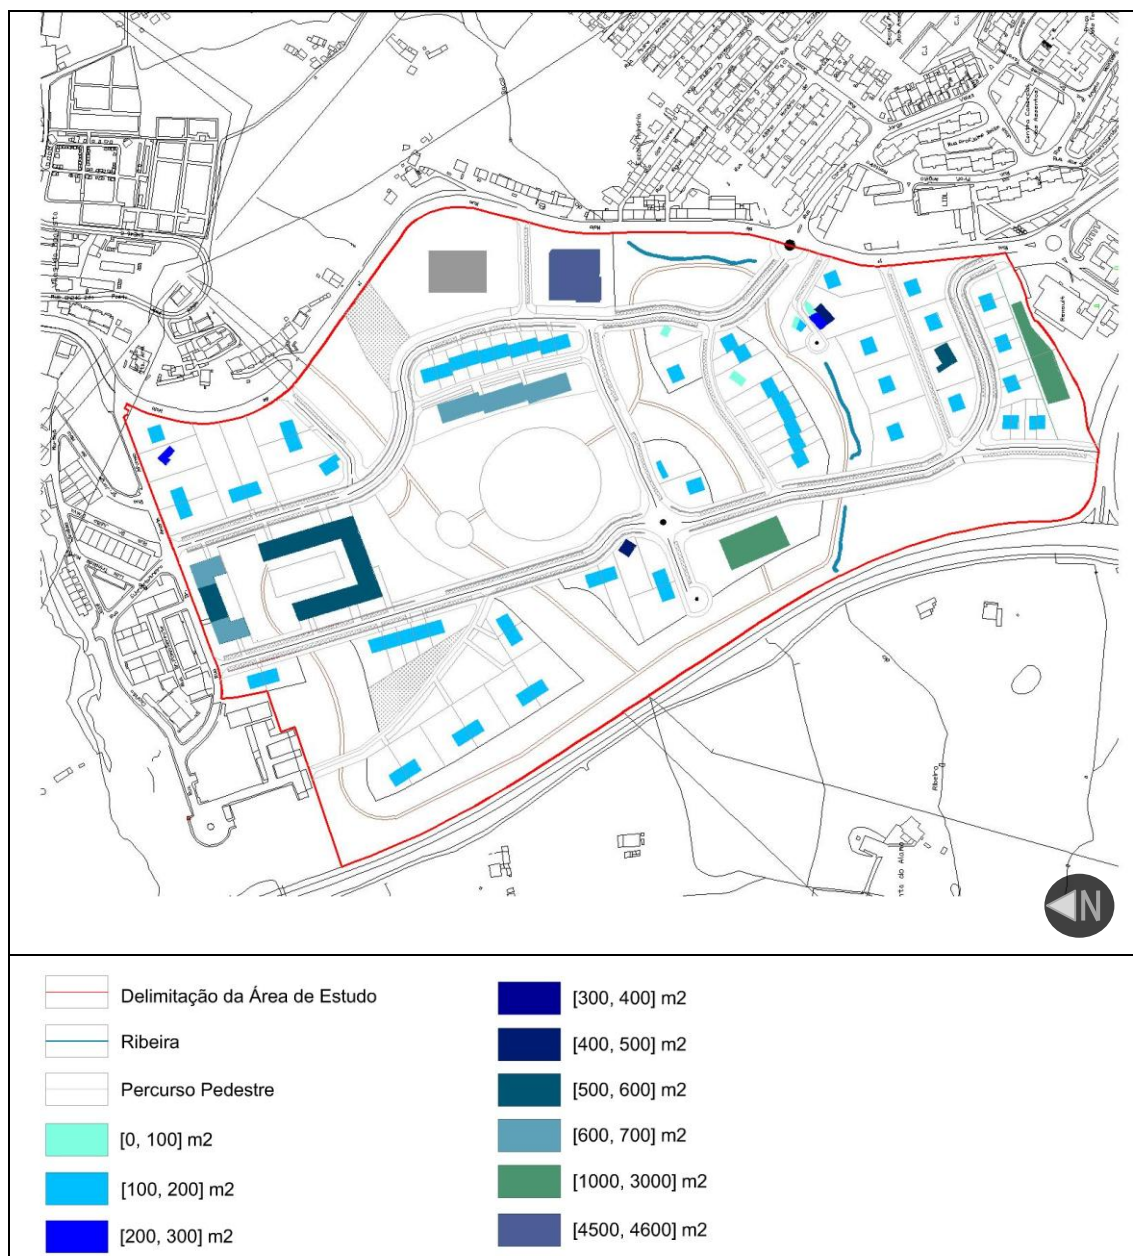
Áreas de Construção do edificado proposto (FONTE: *autor*), [PLANTA B/27]; (Escala: gráfica)
